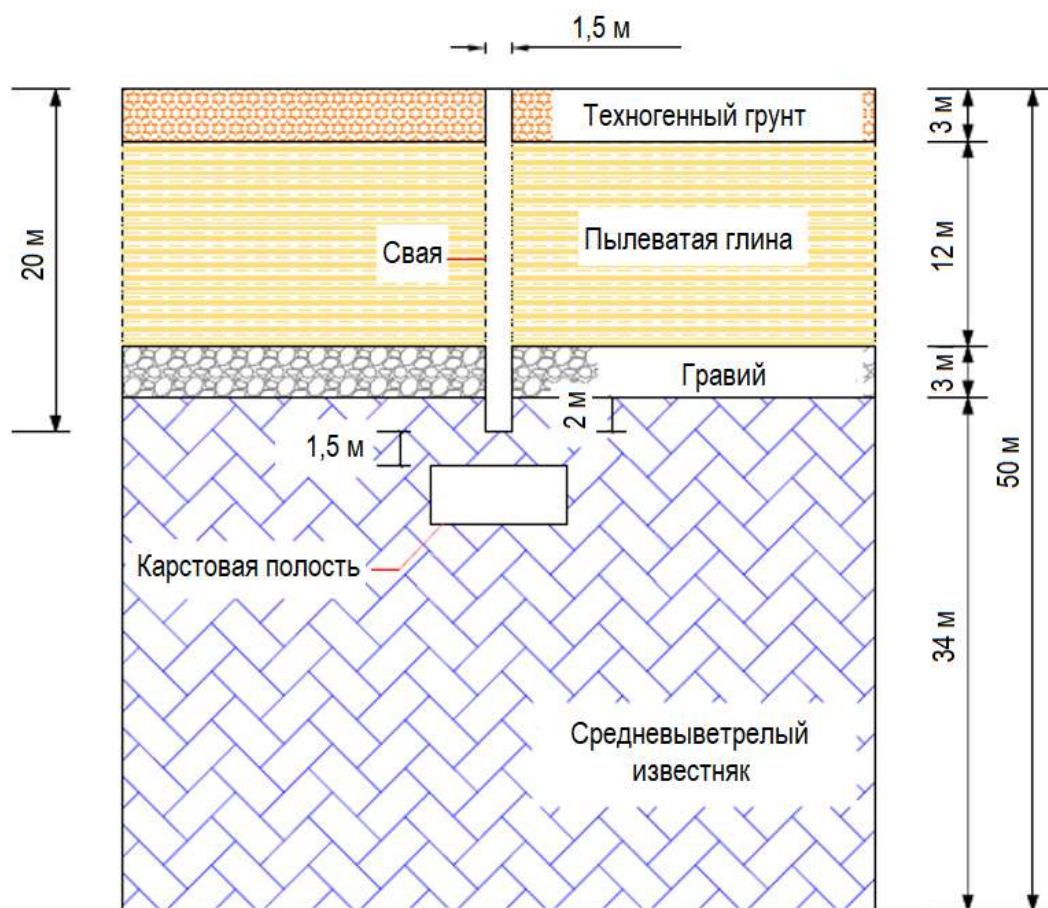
Посадка испытуемой сваи на инженерно-геологический разрез [141]
